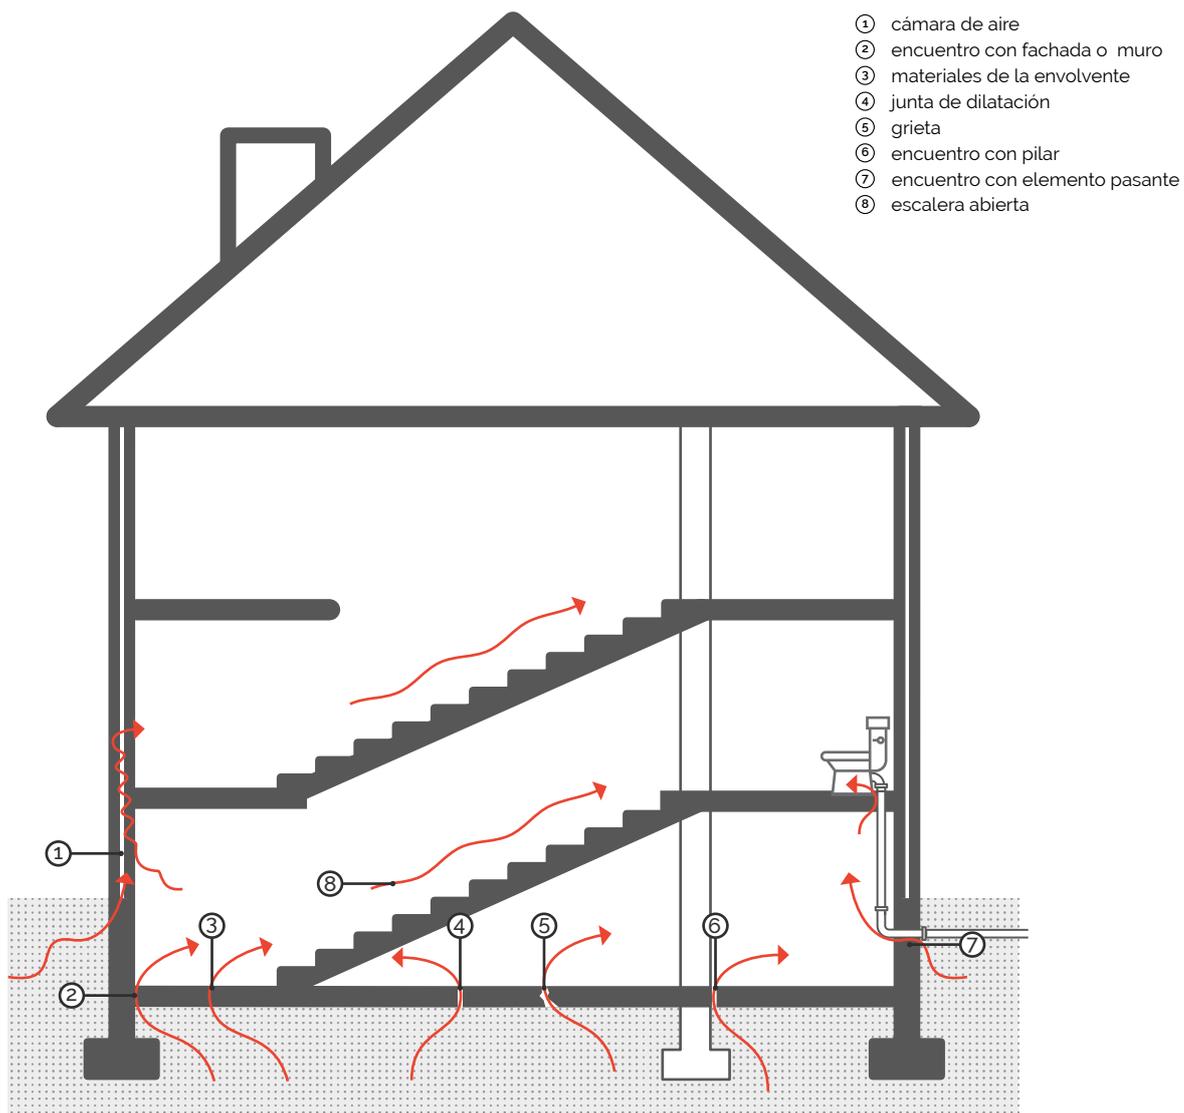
Vías más usuales de entrada de radón procedente del terreno y de comunicación con otras plantas
